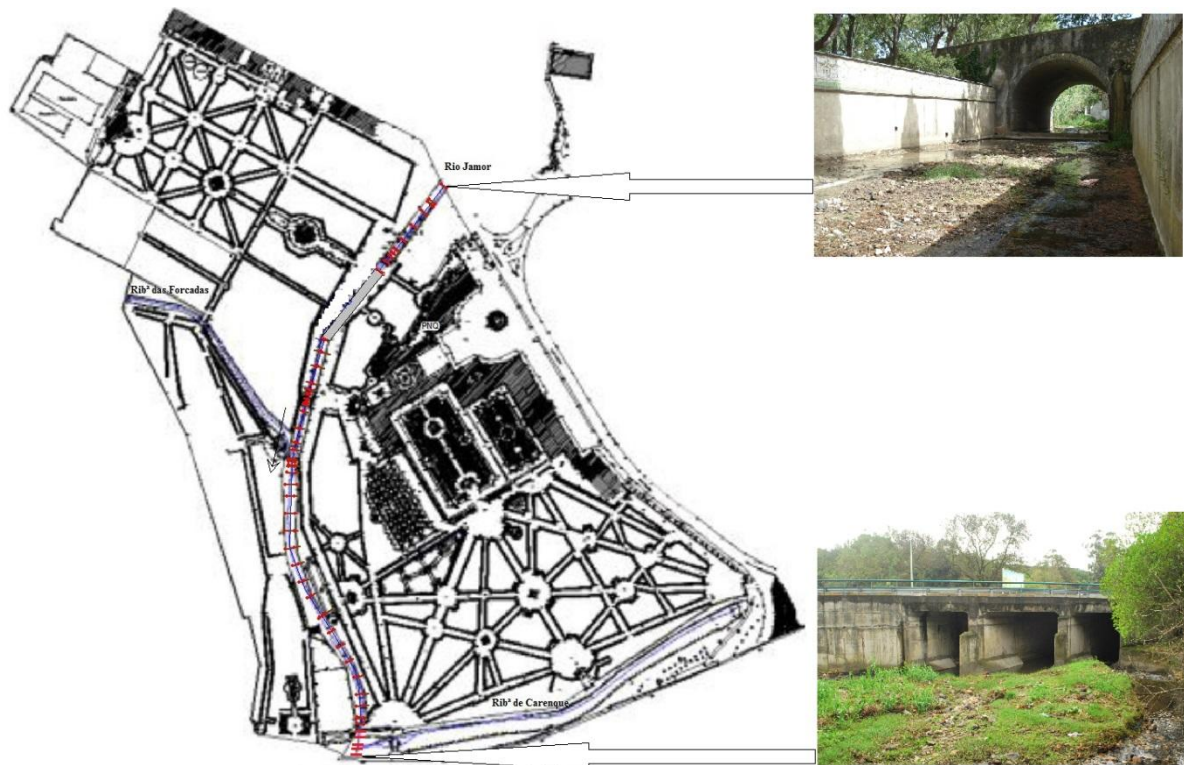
Esquema das secções transversais consideradas: Hipótese b)
